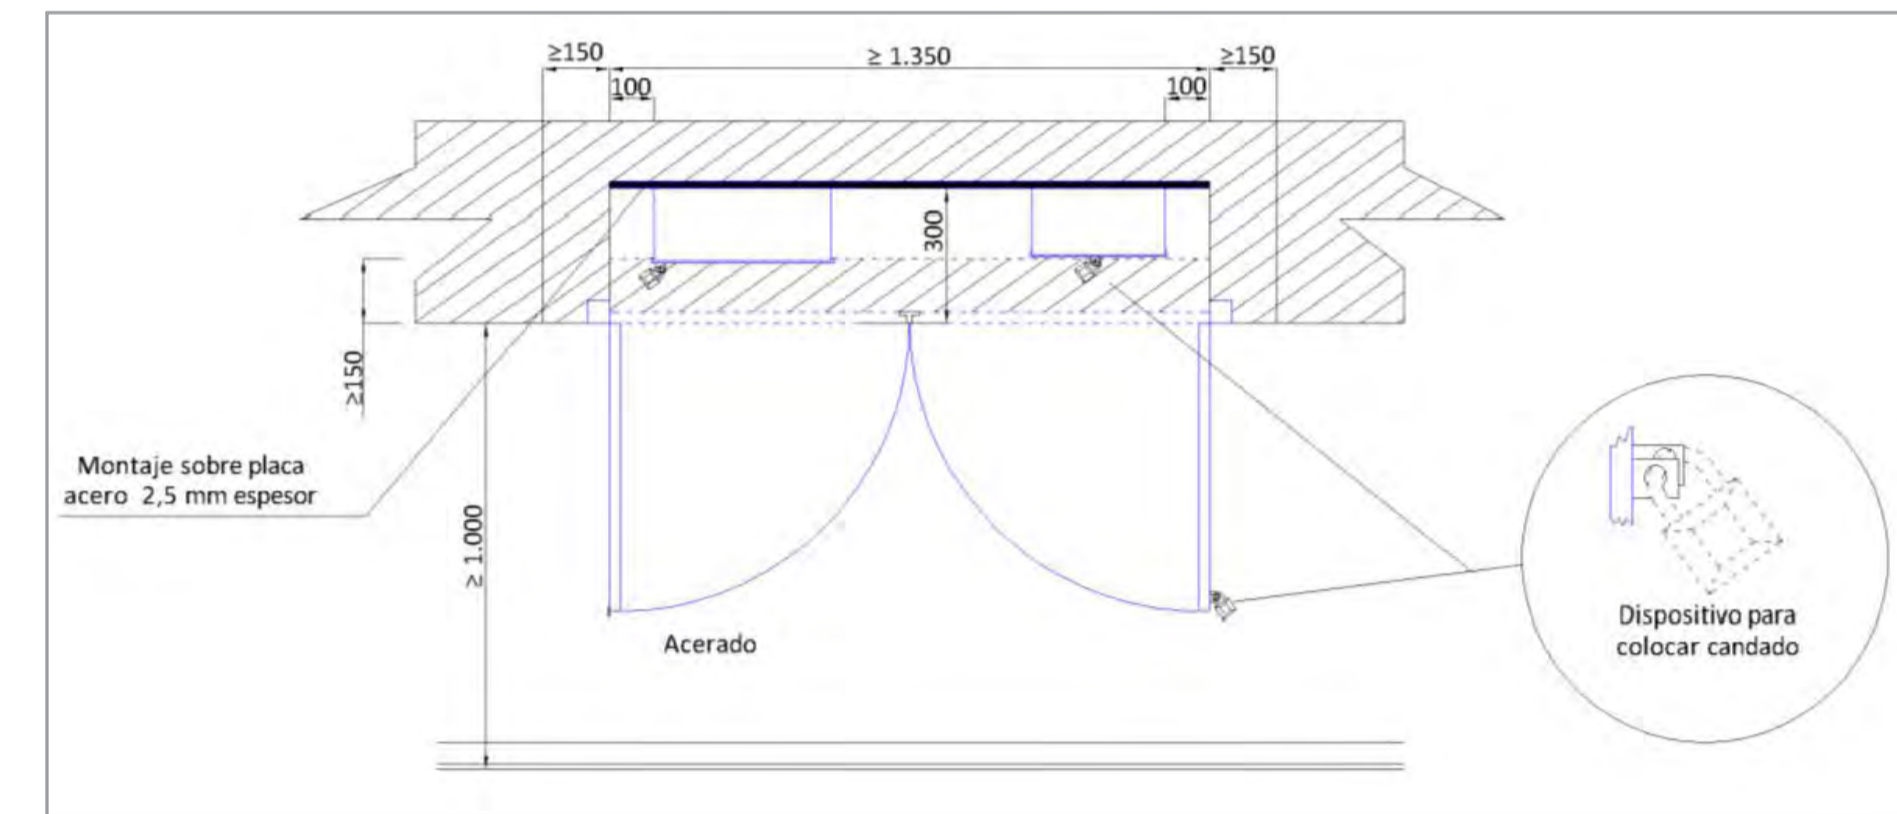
Instalación CGP y CS montaje horizontal. Planta.
